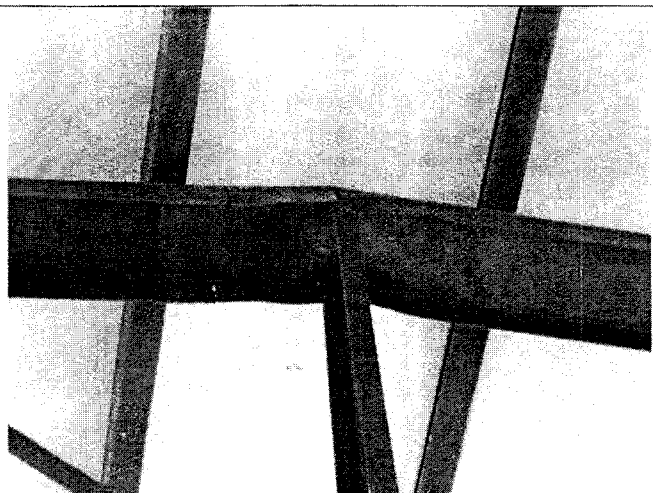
Estrutura metálica com peças reaproveitadas "sem qualidade", "amassadas" e com pontos de ligação falhos.
